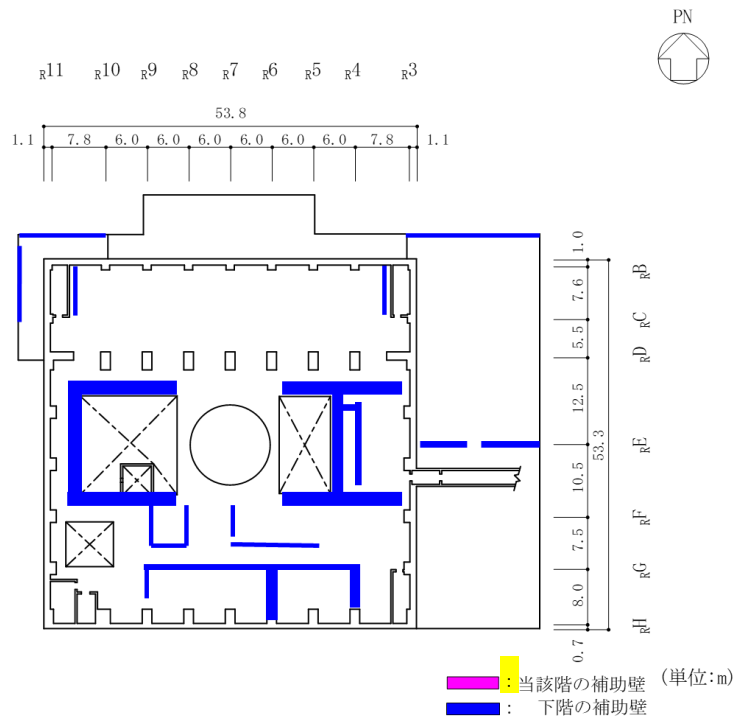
(6) 補助壁の配置図 (EL 42.8m)
